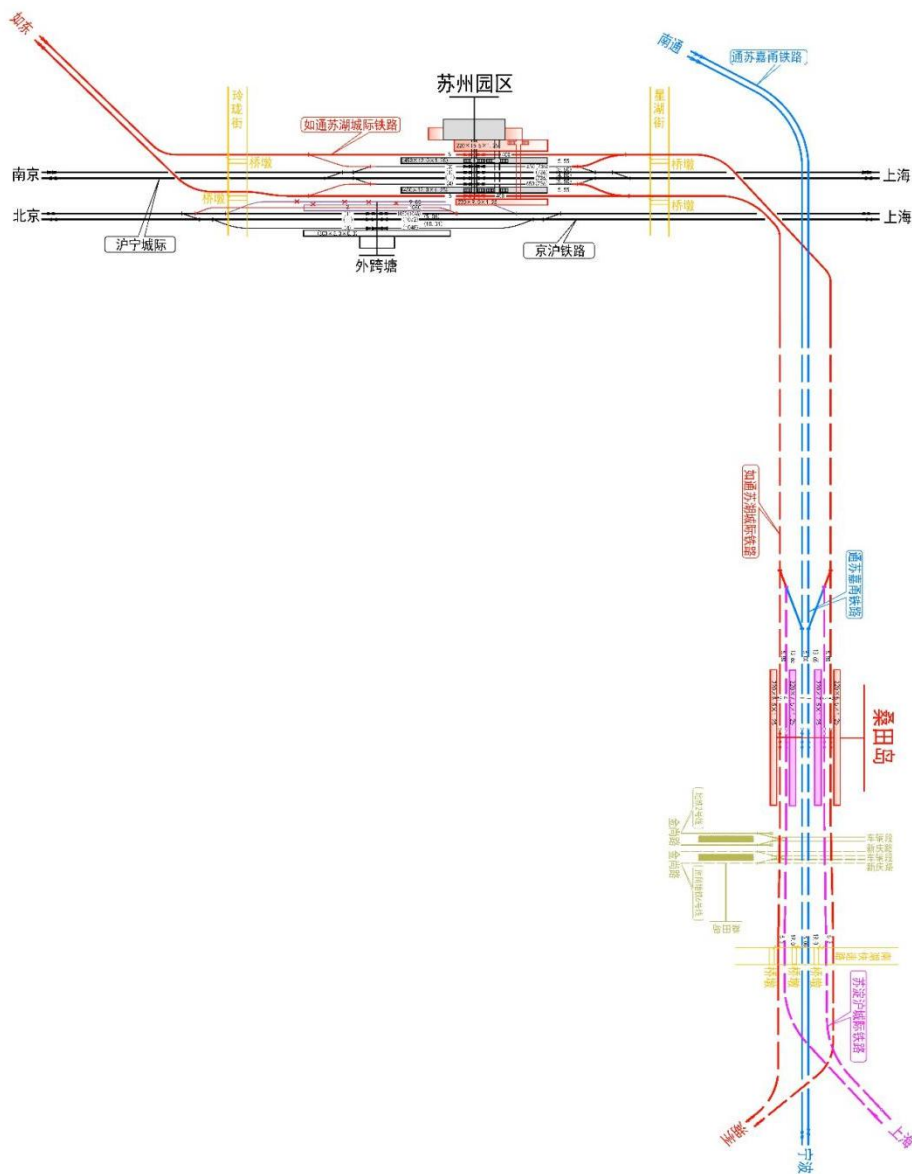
共线方案苏州园区站及桑田岛站平面布置示意图
